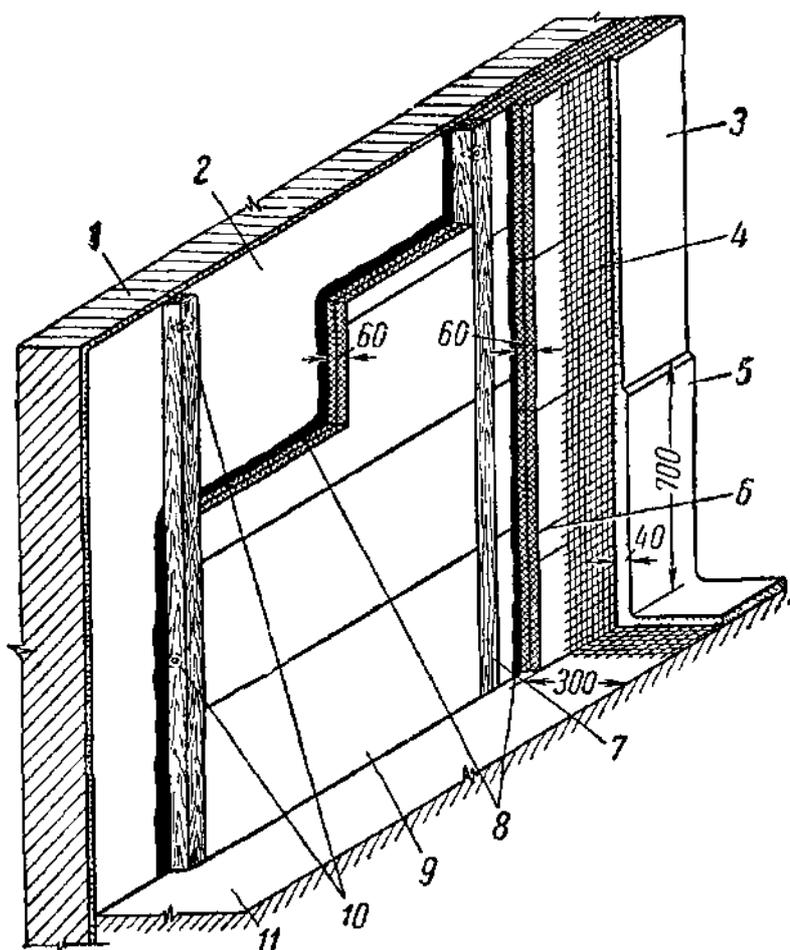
Четырехслойная изоляция кирпичных стен торфофлитами:
